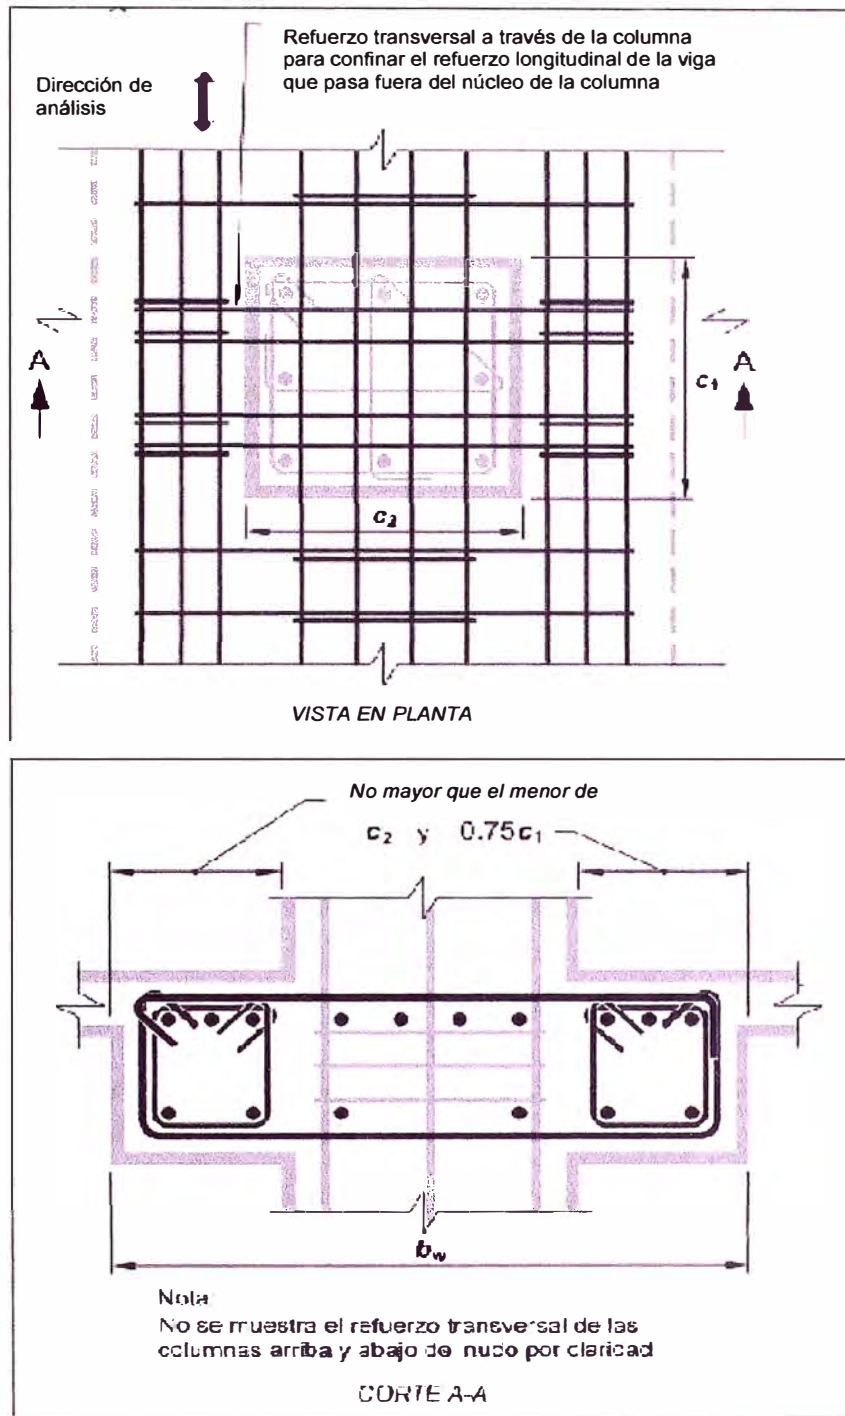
Ancho de vigas admisibles en pórticos de momento (1)
